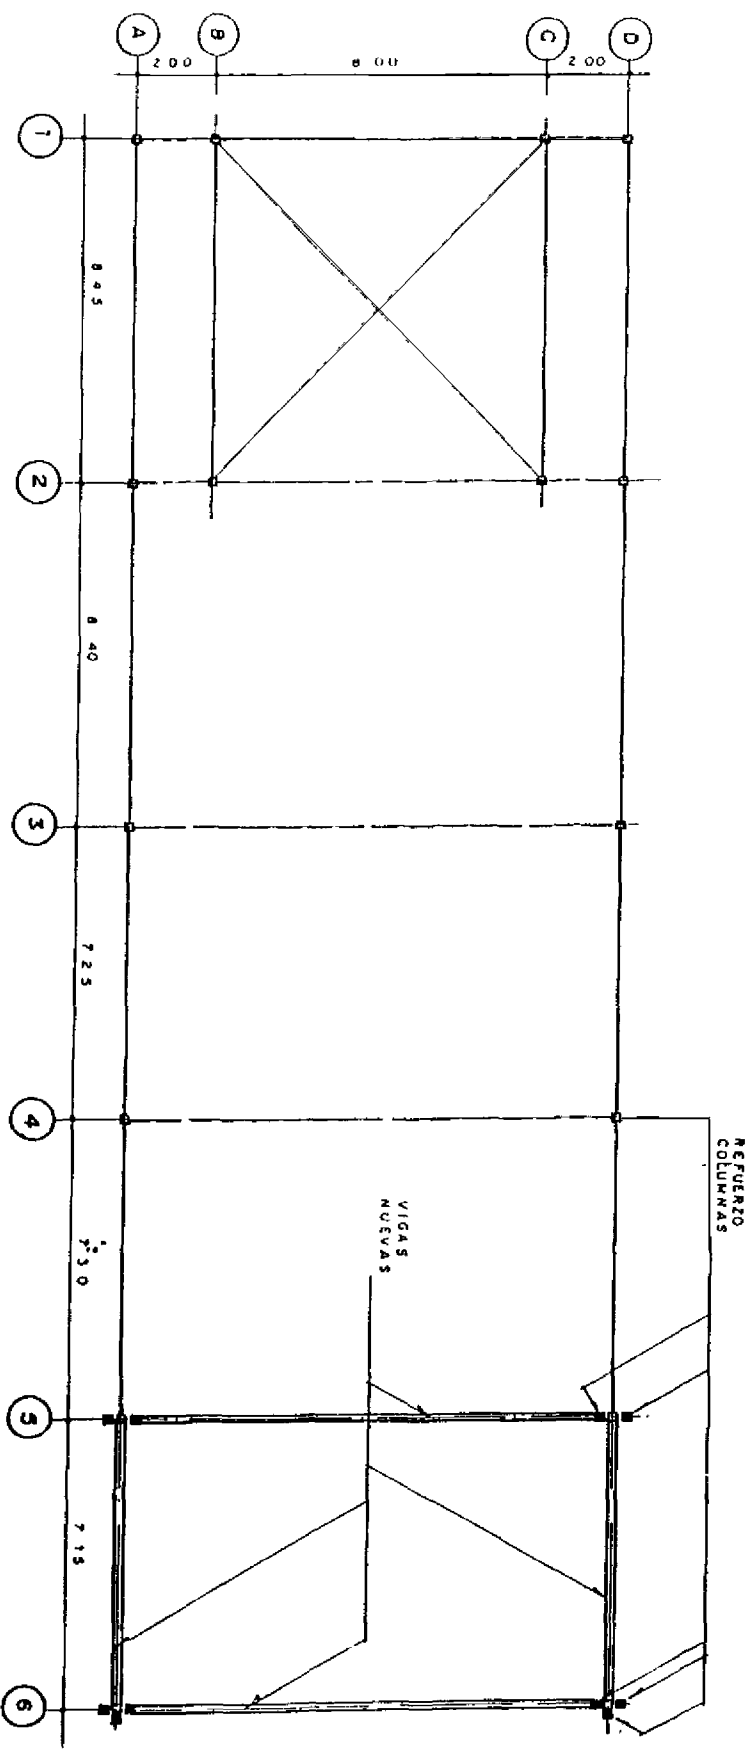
REFUERZO METALICO A NIVEL DE TECHO
